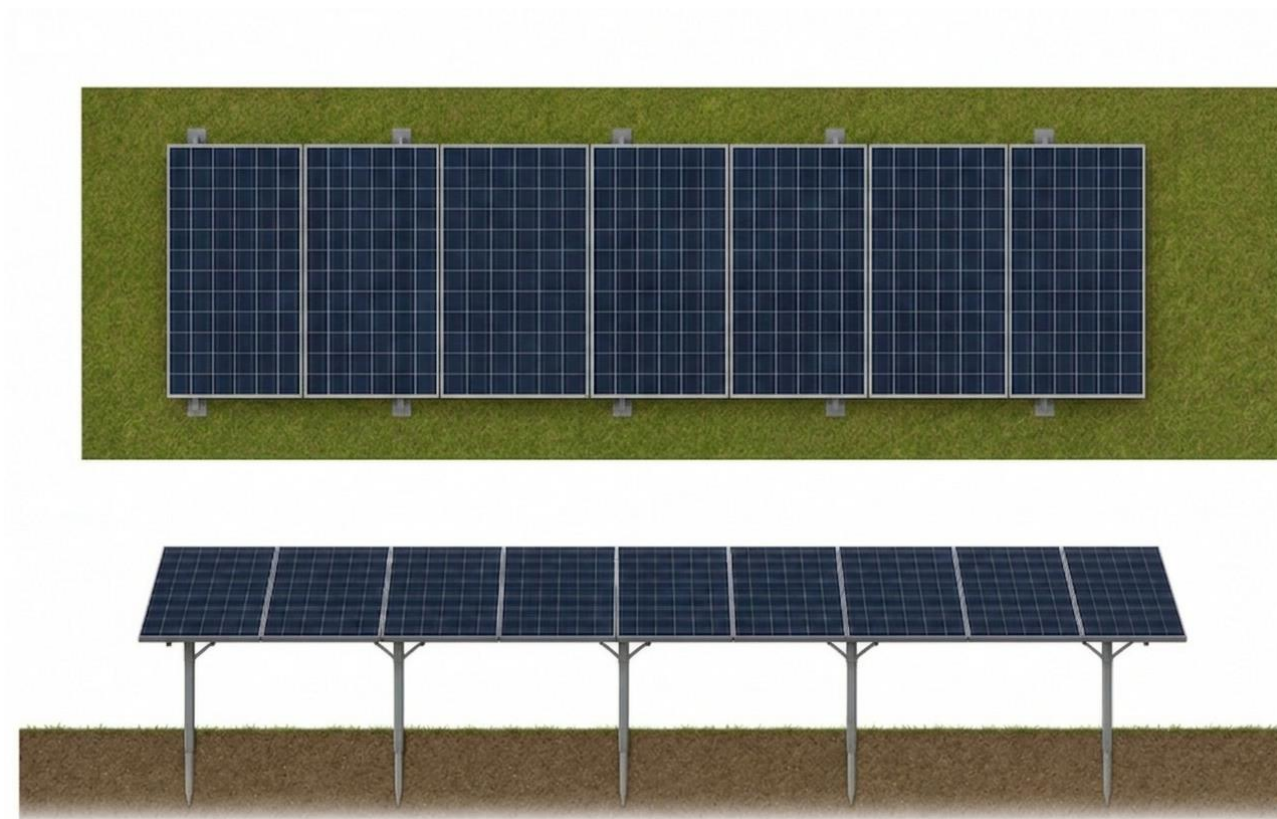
Pianta e Prospetto schema tipo modulo fotovoltaico
